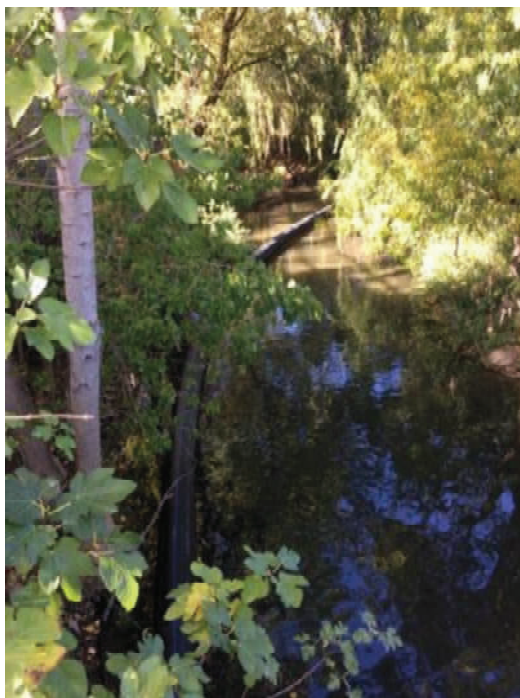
Tubo sobre o rio a ser puxado para o furo
